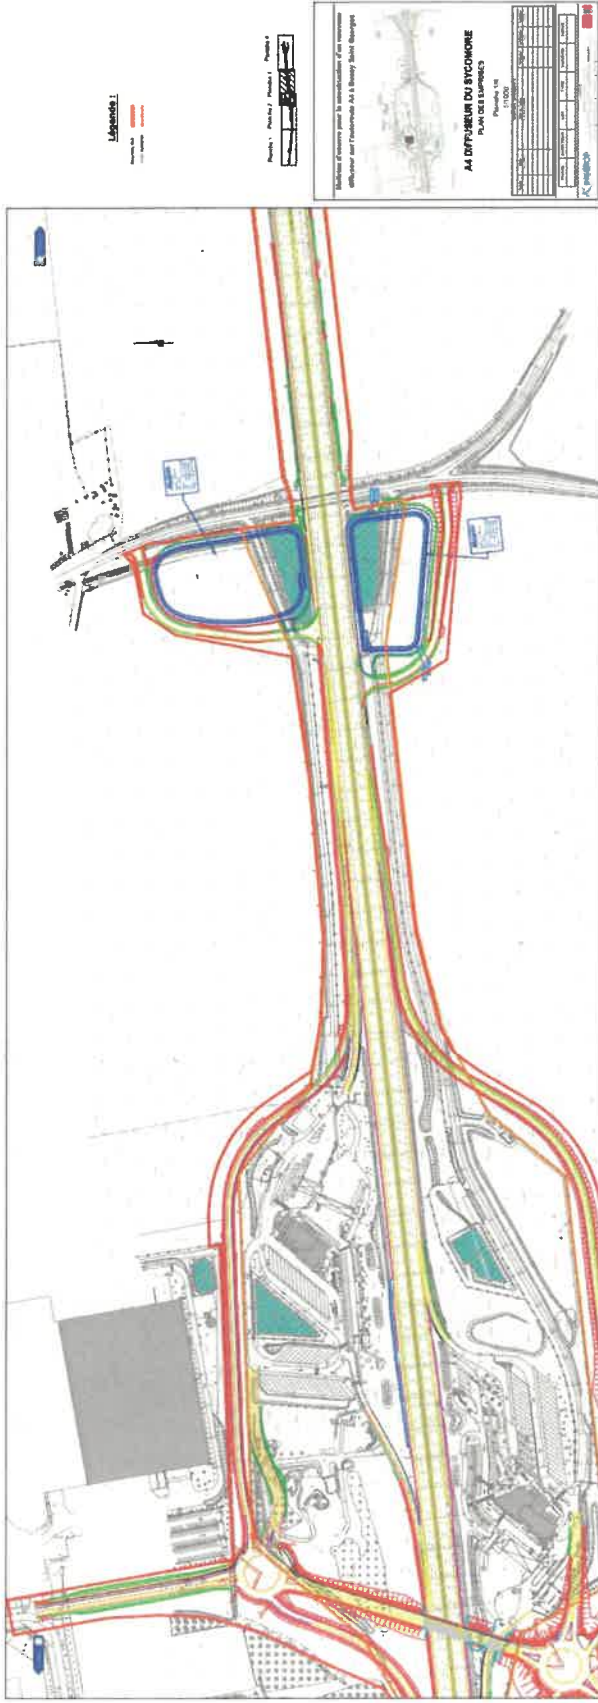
Plan des emprises travaux au droit du Parc d'activités Gustave Eiffel, commune de Bussy-Saint-Georges
